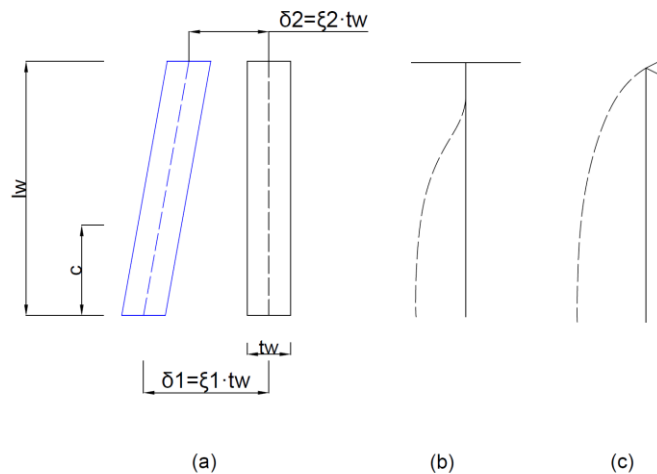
Idealización del pandeo fuera del plano para un muro rectangular, vista en planta (a); Perfil de desplazamiento fuera del plano muros T considerando condiciones de apoyo (b); Perfil de desplazamiento fuera del plano muros rectangulares considerando condiciones de apoyo.
